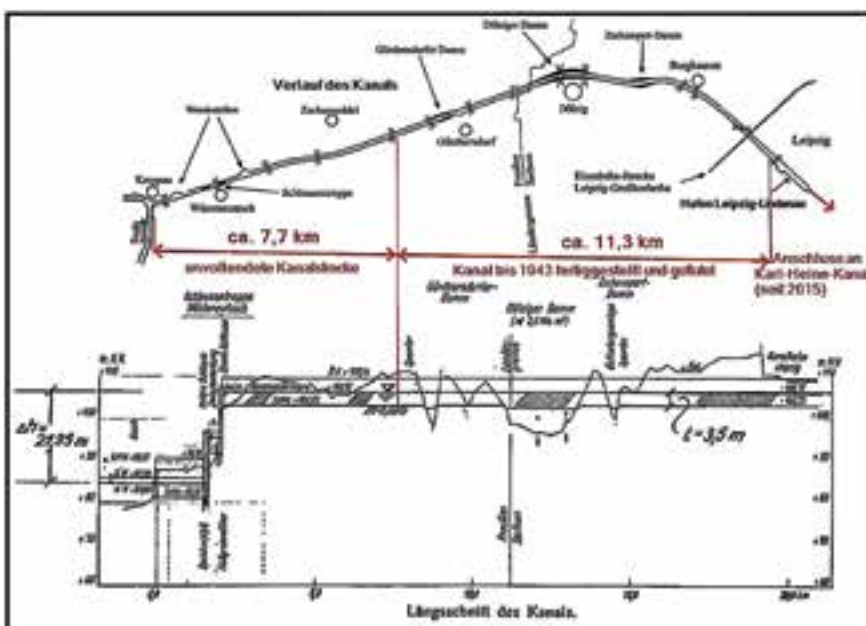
Lageplan und Längsschnitt des Elster-Saale-Kanals (Nach Jordan/Gerstenberger – Die Bautechnik 1936, S.524 – 530)
